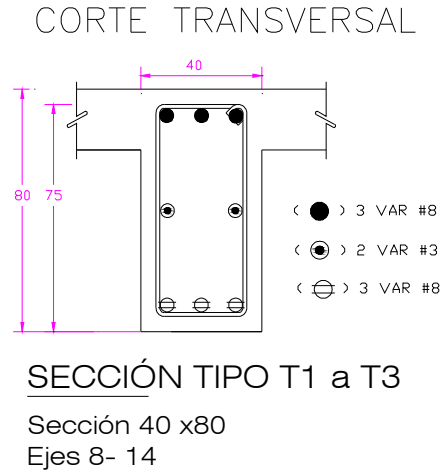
12 Detalle de armado de contratrabe Sección Tipo T1 a T4. Corte transversal
